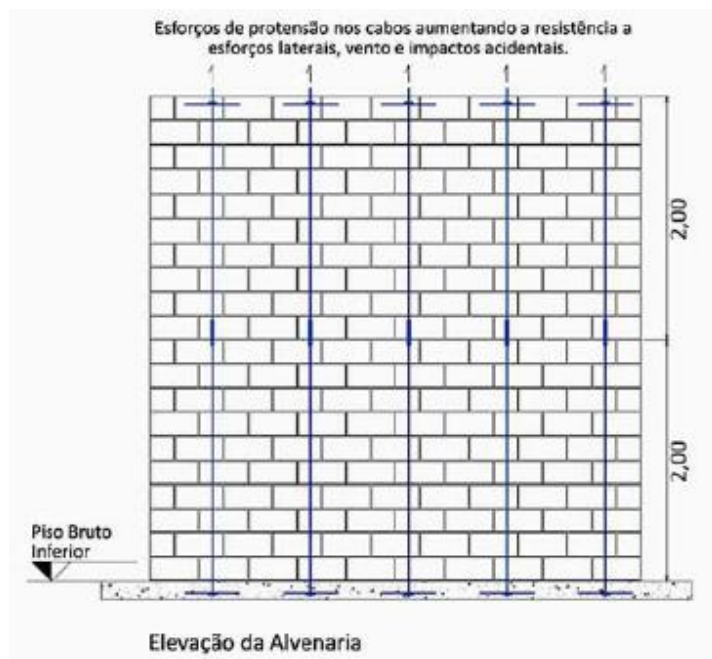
Alvenaria Estrutural Armada ou Parcialmente Armada
